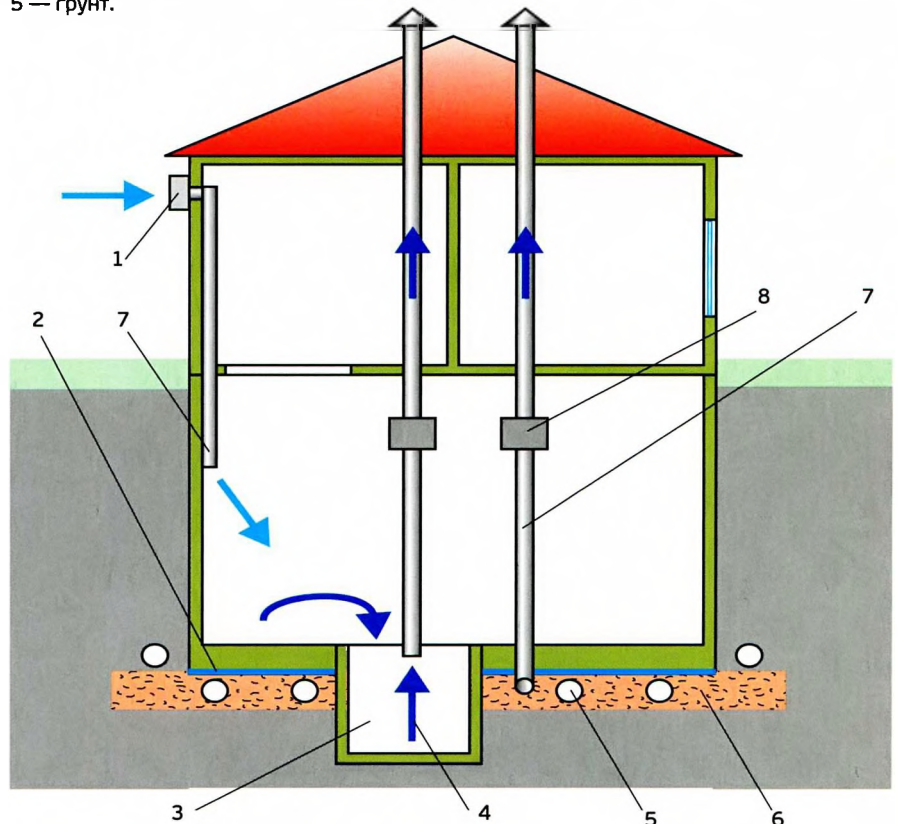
Система вентиляции при организации радоновой защиты: 1 — приточный канальный вентилятор; 2 — паробарьер (гидроизоляция) из ПВХ-плёнки; 3 — дренажный приямок из бетона или пластика; 4 — радон; 5 — дренажные трубы для отвода радона; 6 — каптажная подушка из щебня; 7 — вентиляционная труба; 8 — вытяжной канальный вентилятор.
